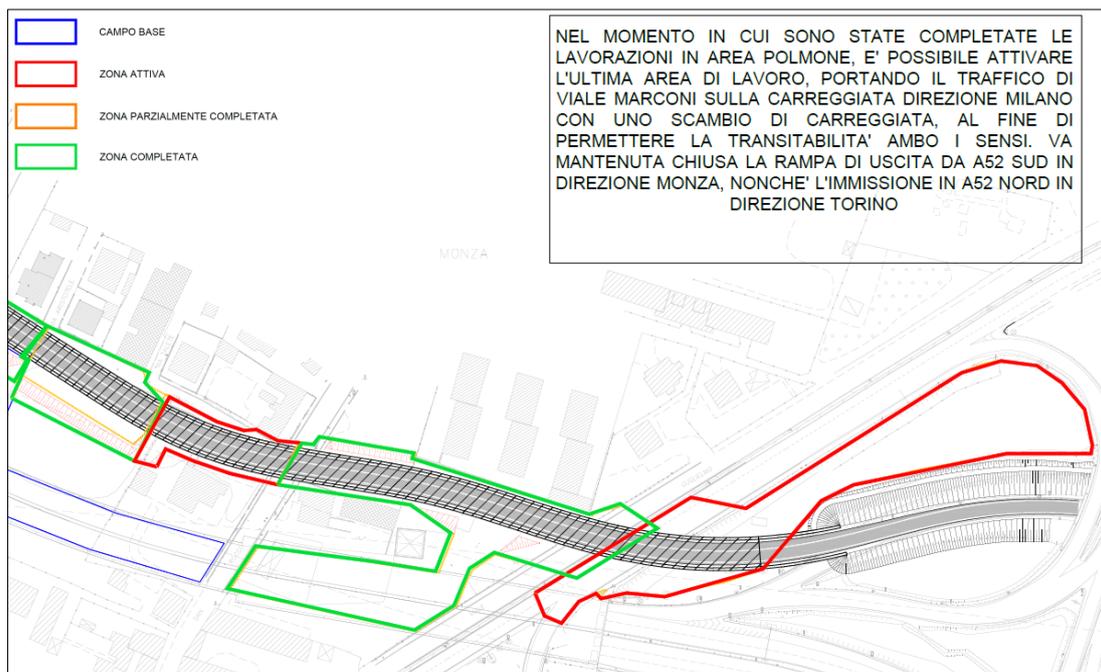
Fasi realizzazione copertura galleria del Piano di Sicurezza di progetto illustrativo della fase H di scavo della galleria
